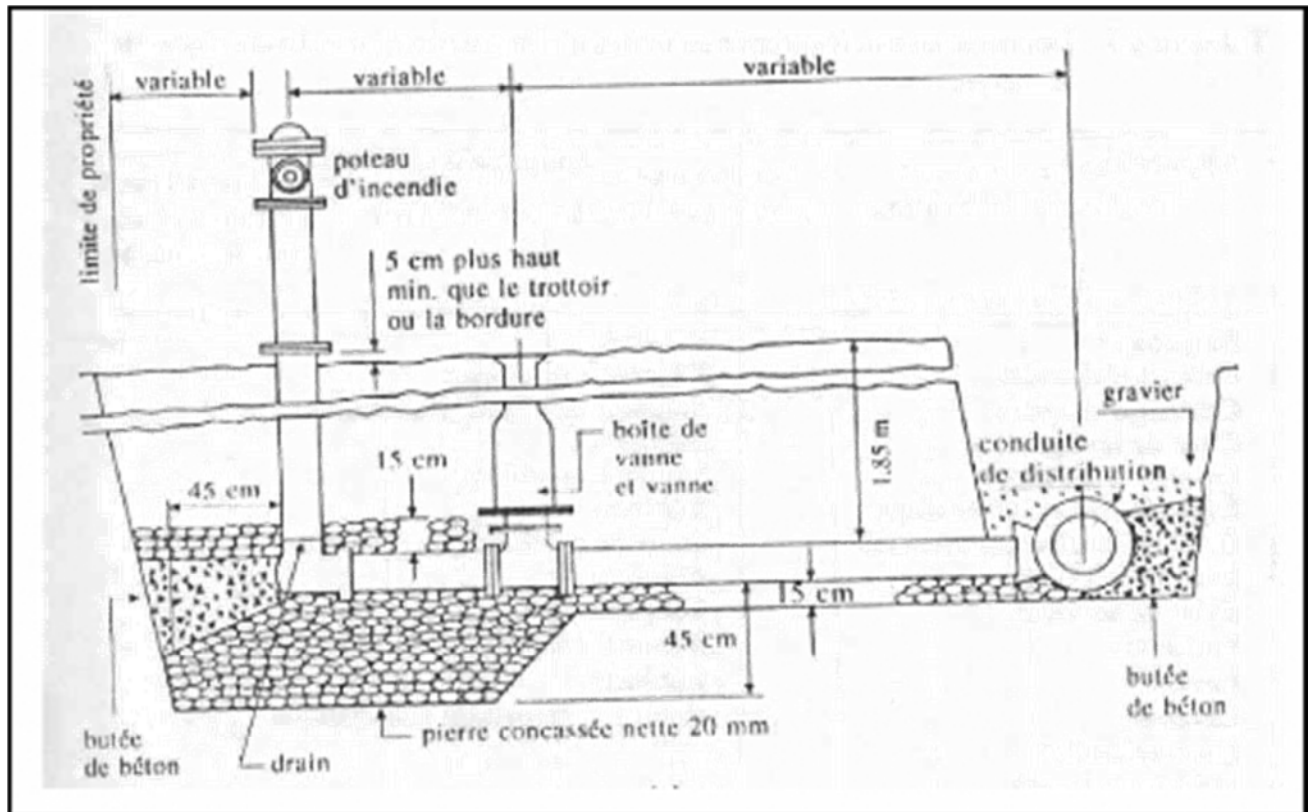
installation d'un poteau d'incendie vue en coupe (Brière ,2009)
